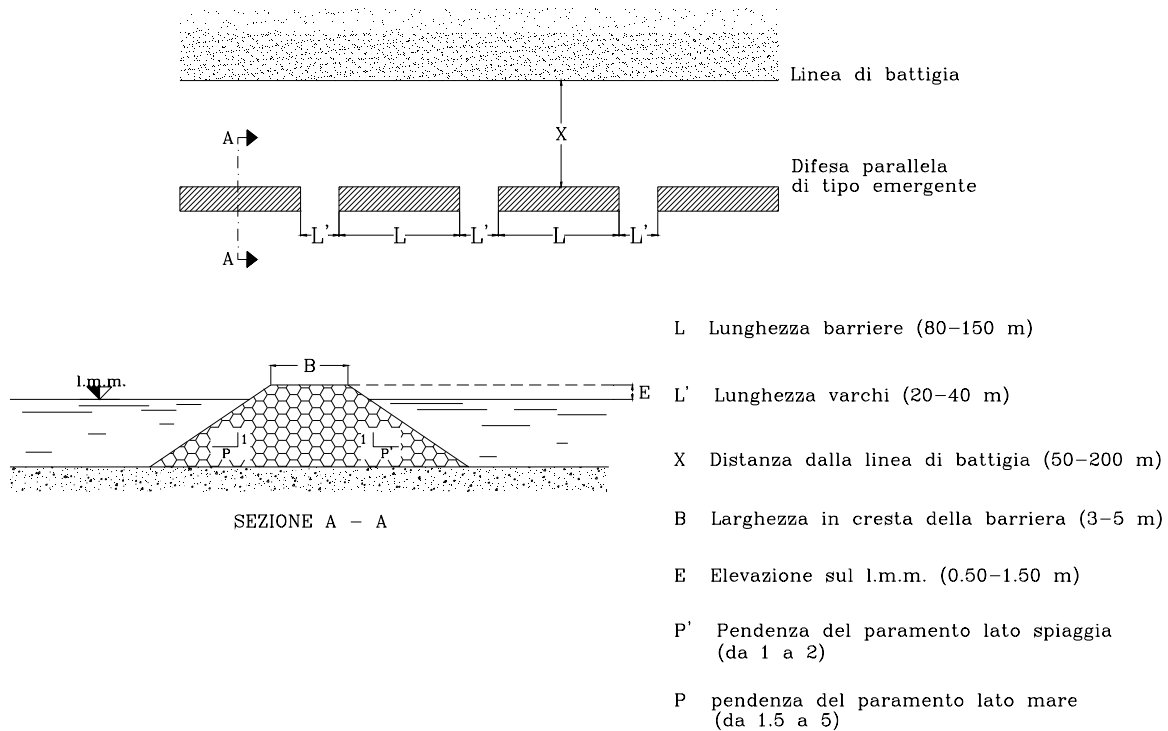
Schema tipo di una sezione e di una pianta di una barriera distaccata del tipo emerso.
